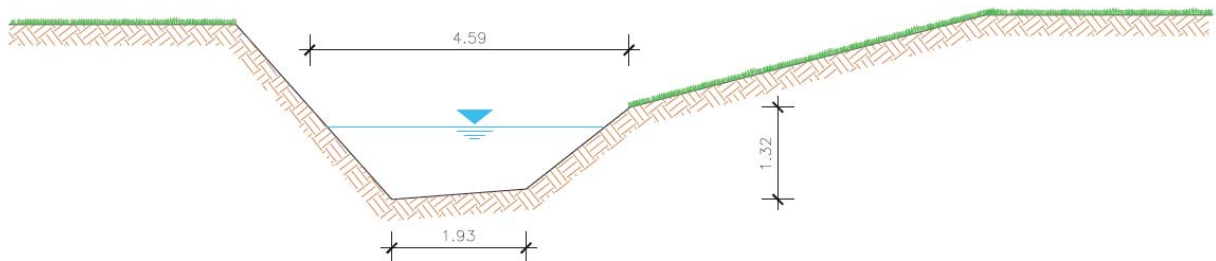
Sezione del canale Staggi 1° ramo, lato est dell'attraversamento stradale
